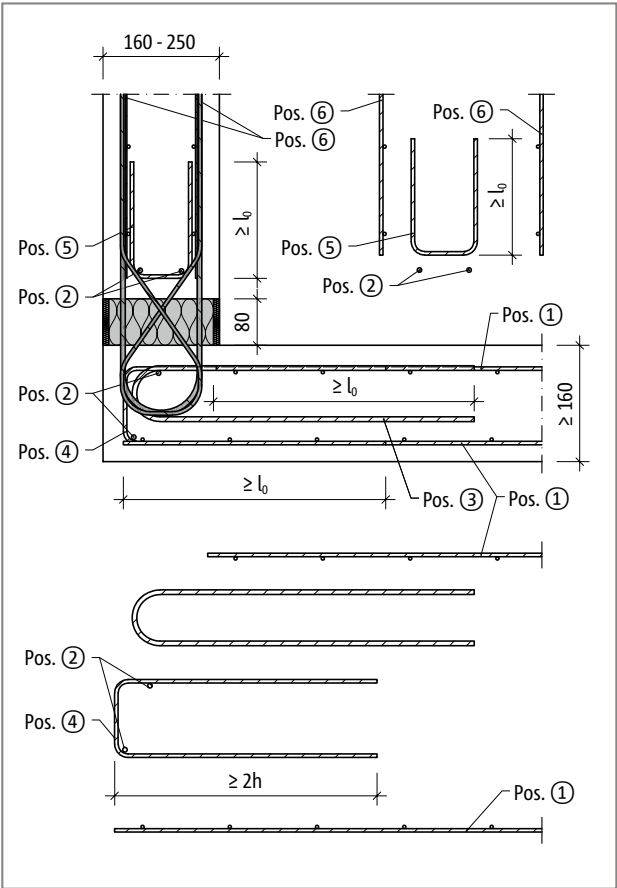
Schöck Isokorb® T tipo AP disposizione verticale: armatura in opera
